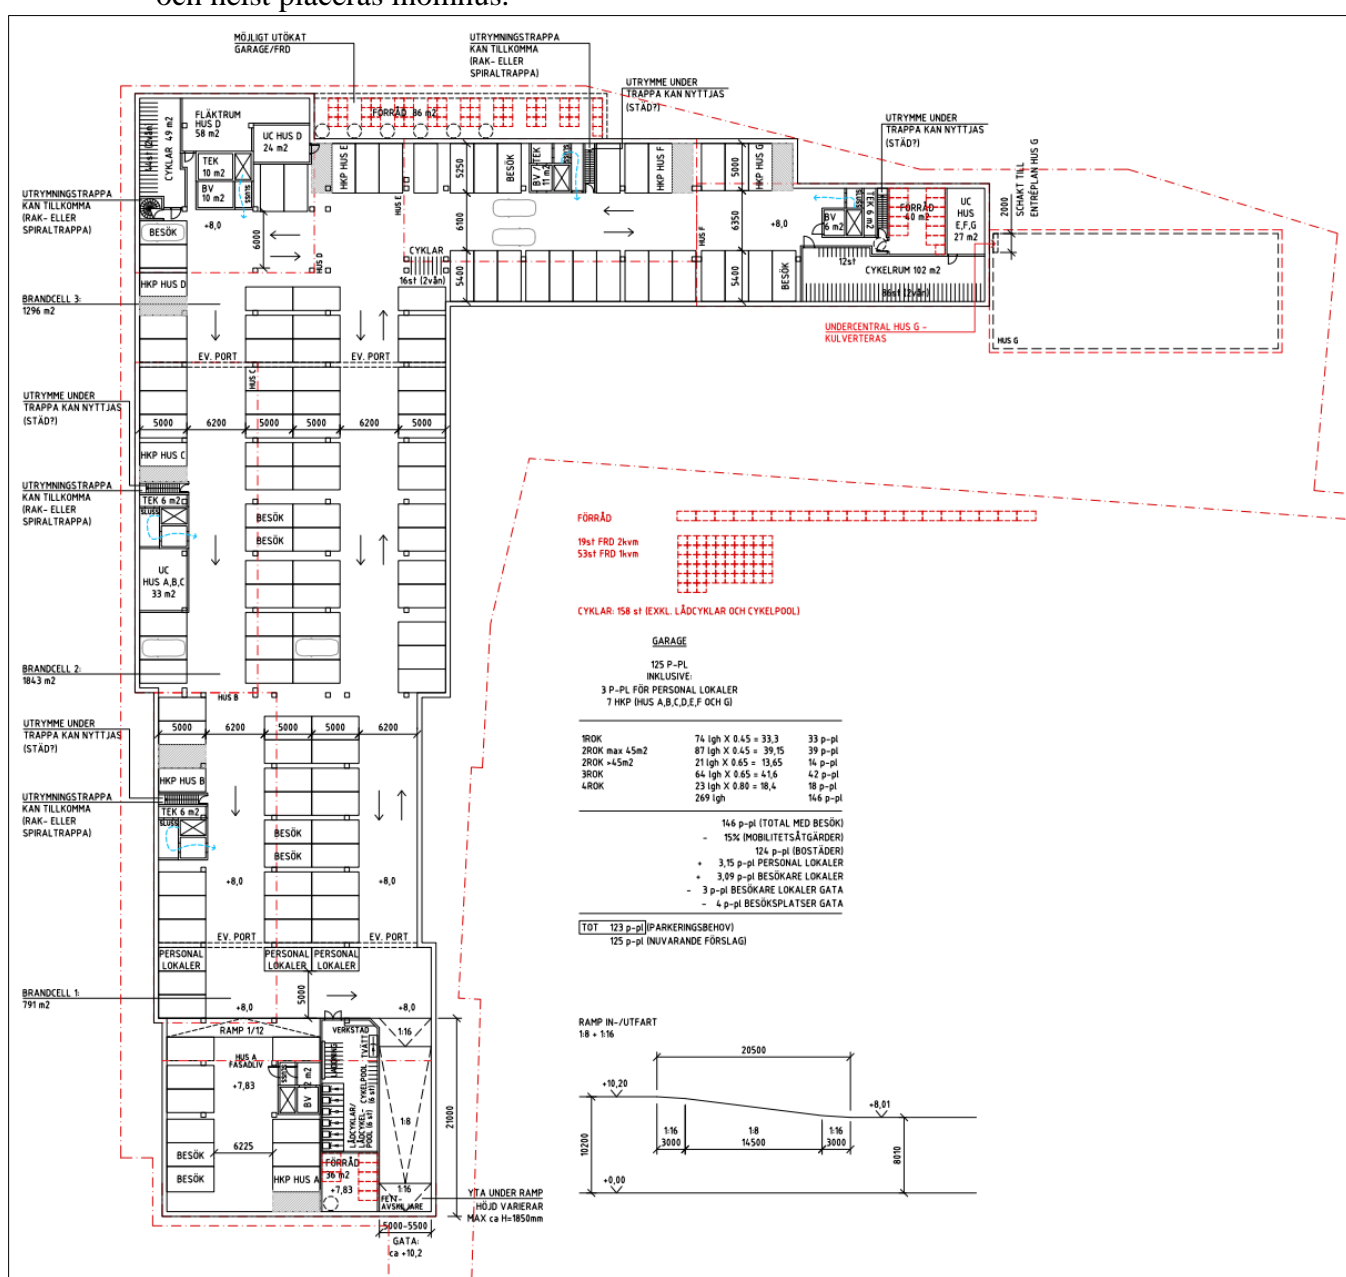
Parkeringsgaraget under det planerade bostadskvarteret
